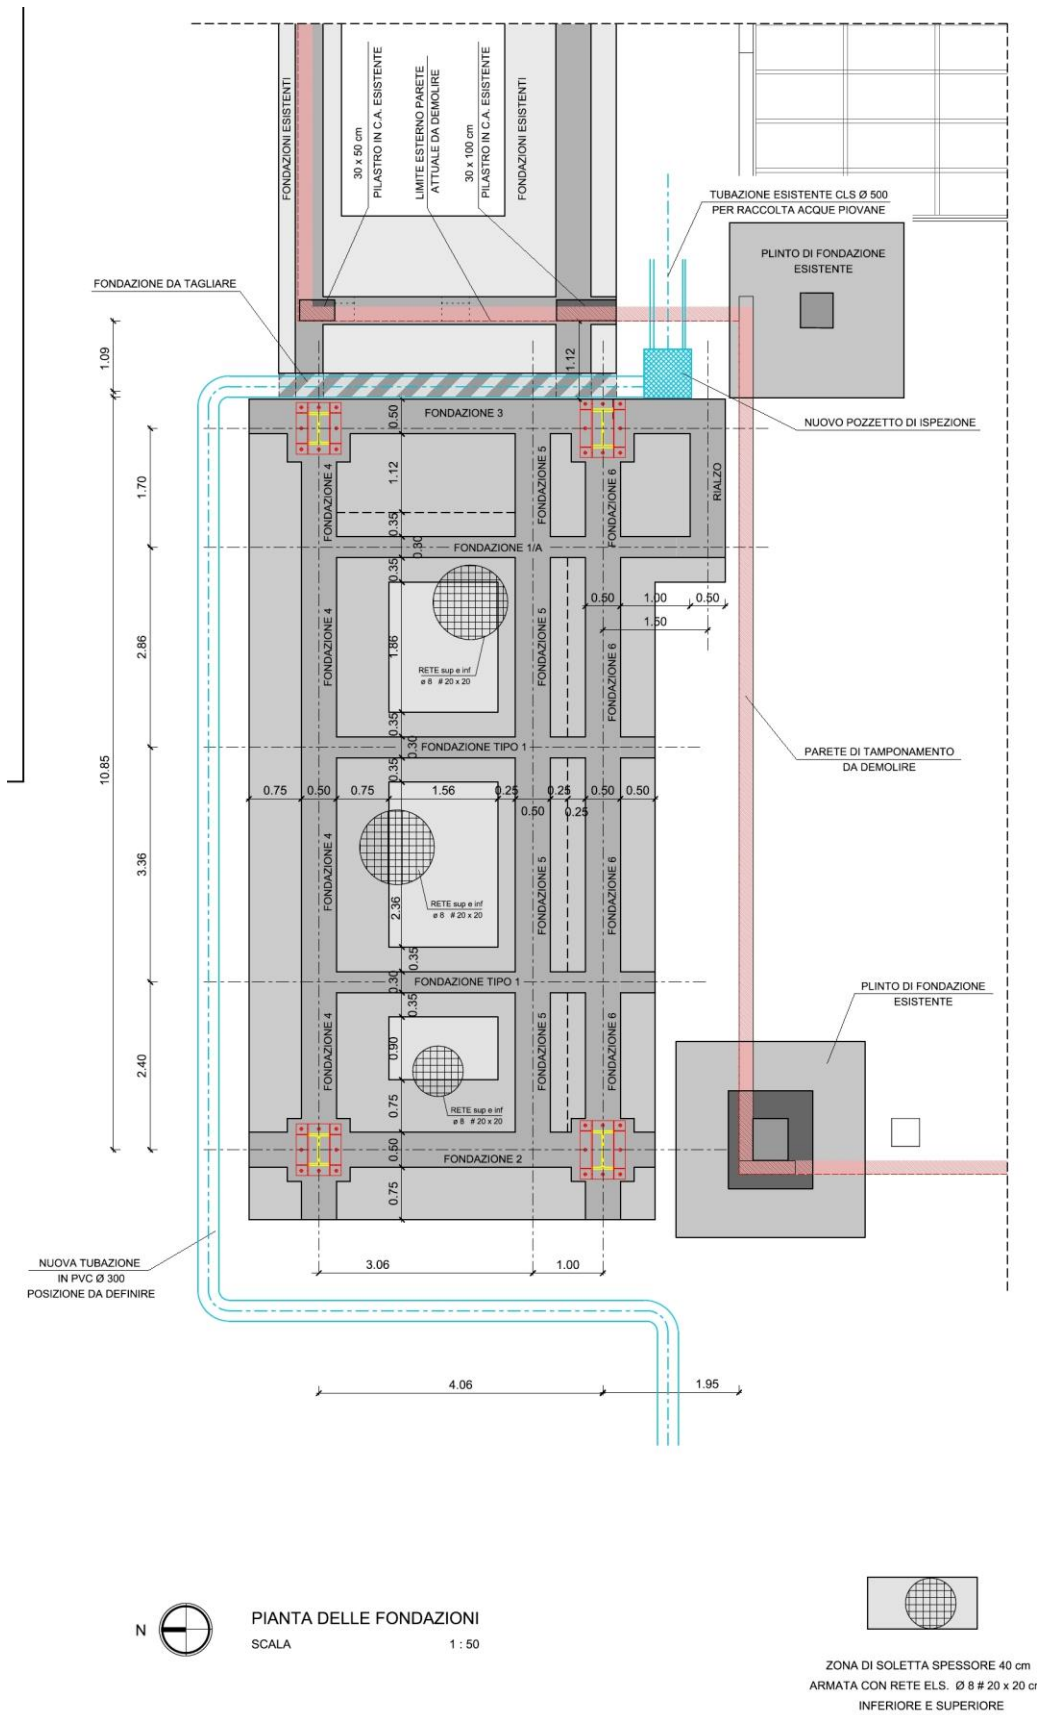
Particolare di A.2009.a.us.T01 - Pianta delle fondazioni
